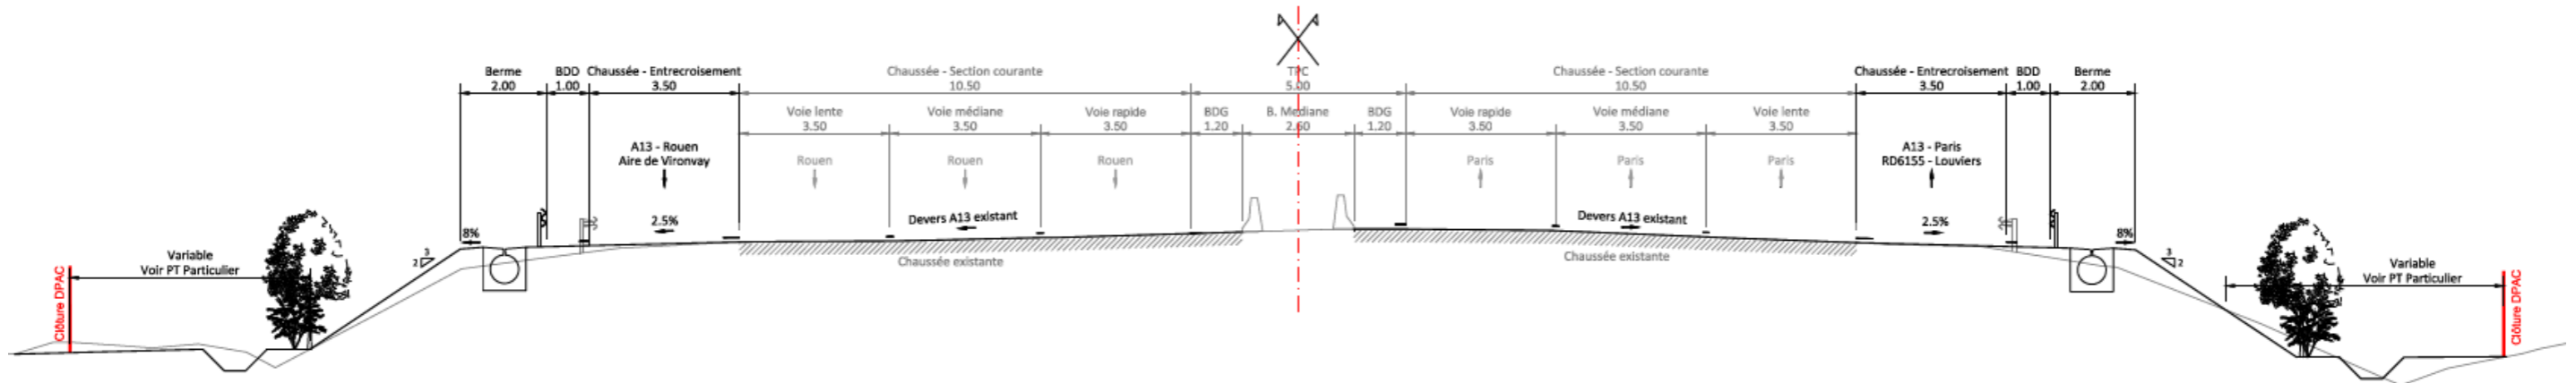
Profil en travers de la section courante au droit des entrecroisements
